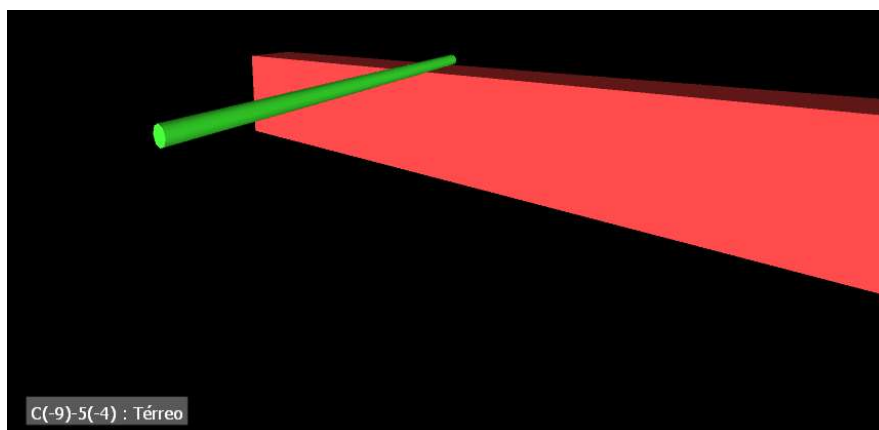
Interferência entre tubulação hidrossanitária e viga baldrame
